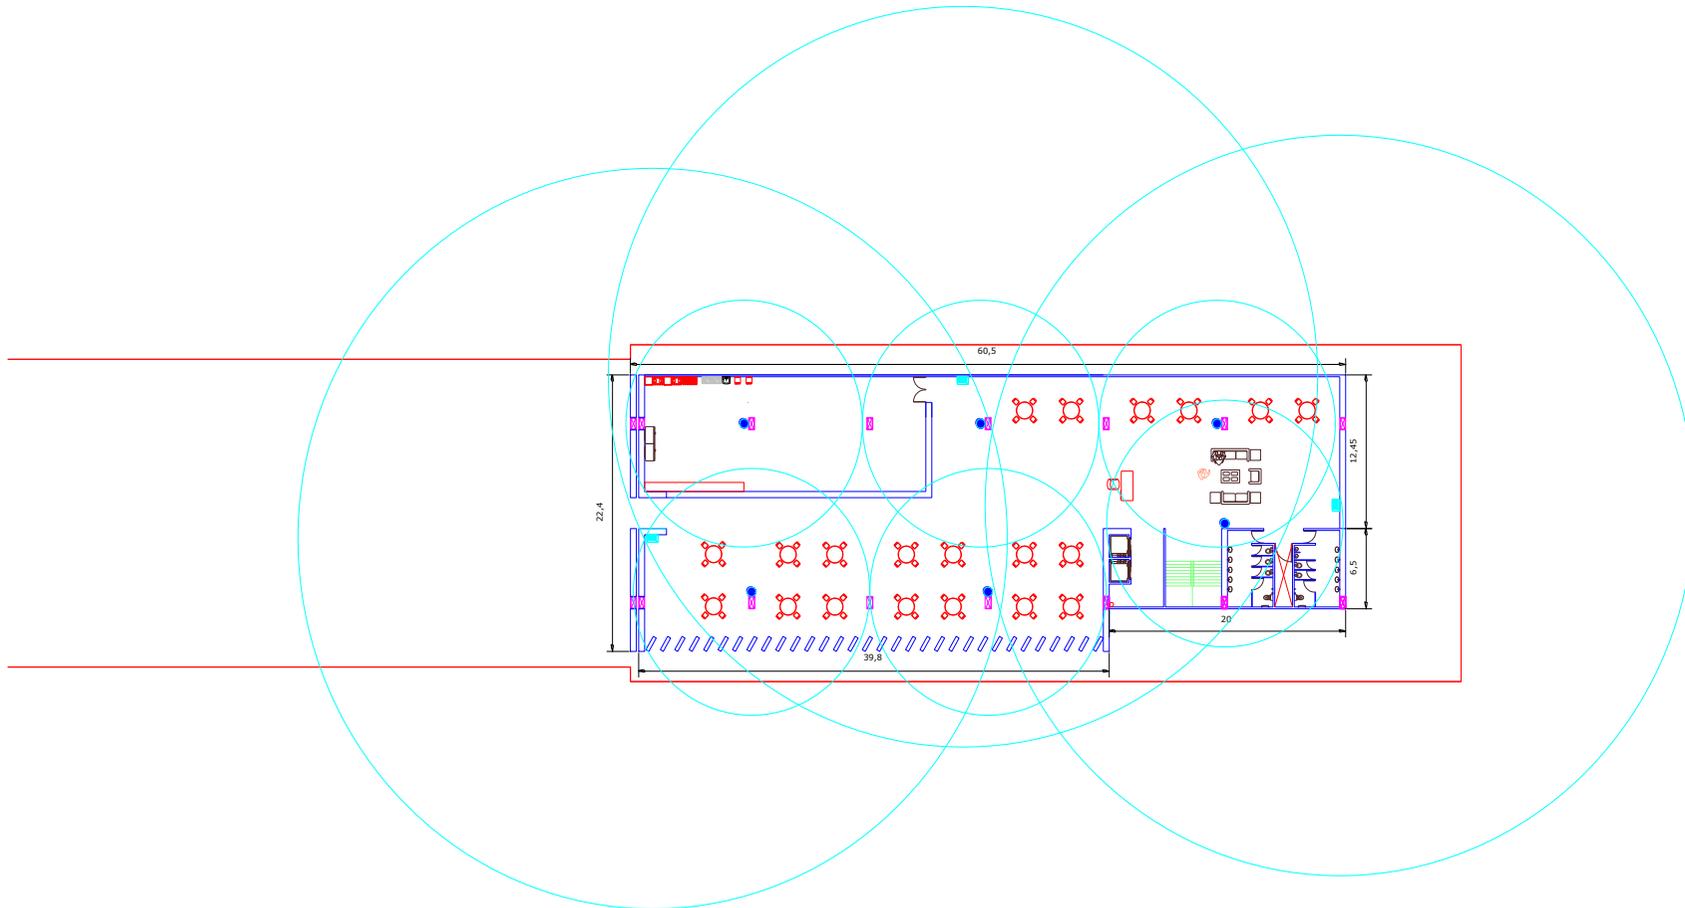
Distribución y cobertura de hidrantes y extintores en la planta tipo 2 (zona de restaurante).
